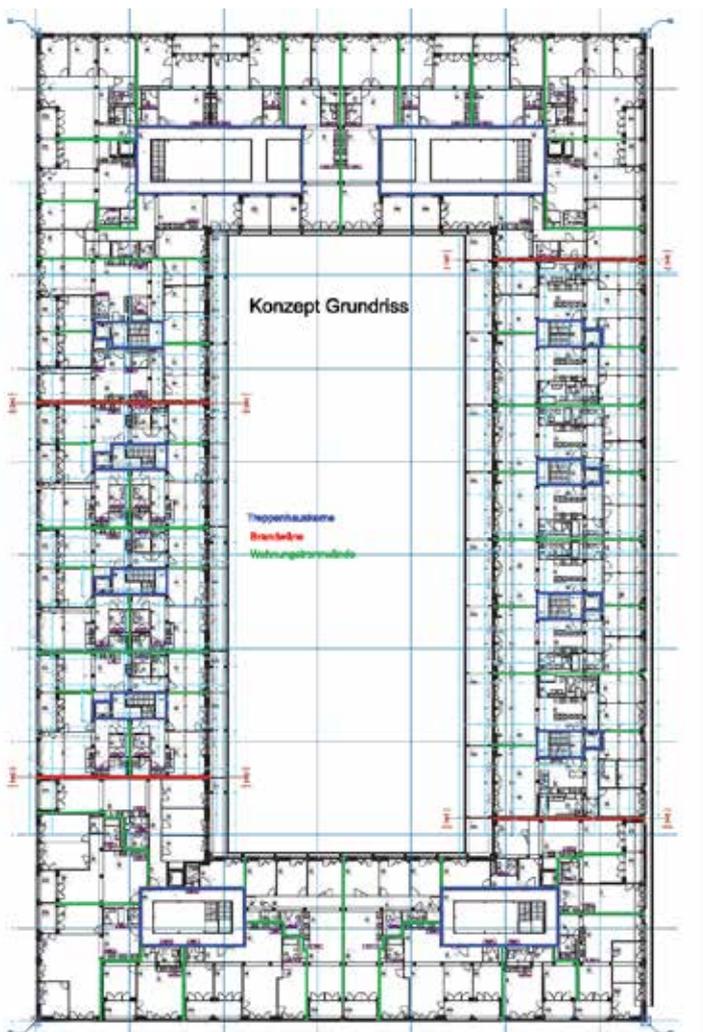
Grundriss mit Wohnungstrennwänden, Treppenhaukernen und Brandwänden (rot) (Bildquelle: Baumberger & Stegmeier Architekten/Timbatec)
